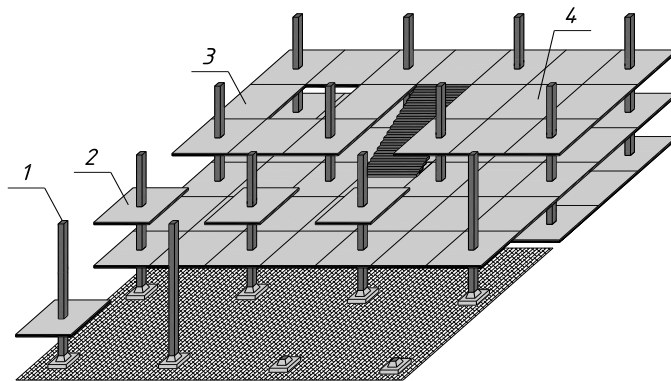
Схема безкапітельно-безбалкової конструктивної системи житлової будівлі: 1 – колона; 2 – надколонна плита; 3 – міжколонна плита; 4 – середня плита
